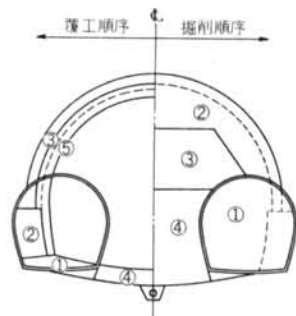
嶺岡トンネル施工順序 (側壁導坑先進上部半断面方式)
